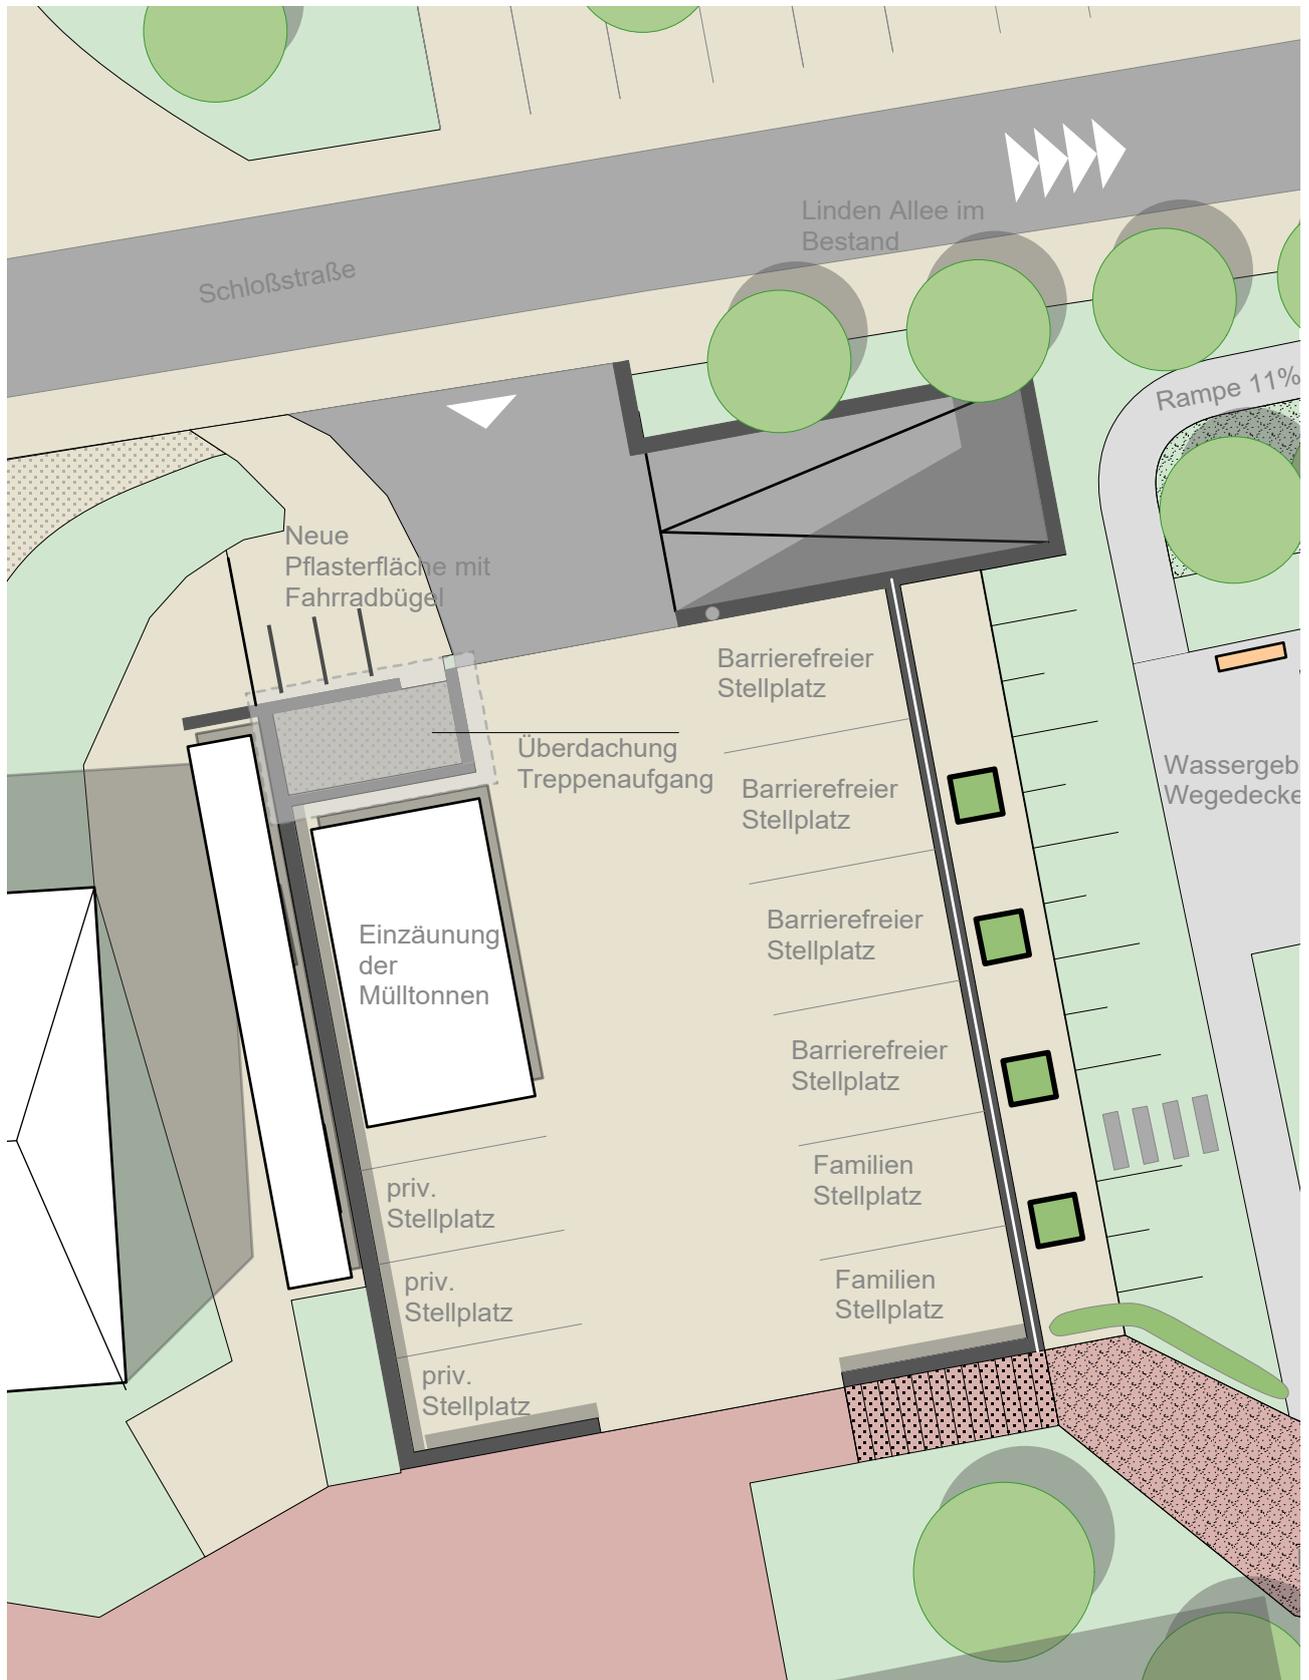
Lageplan mit Darstellung der neuen Einhausung der Müllcontainer 1:200
